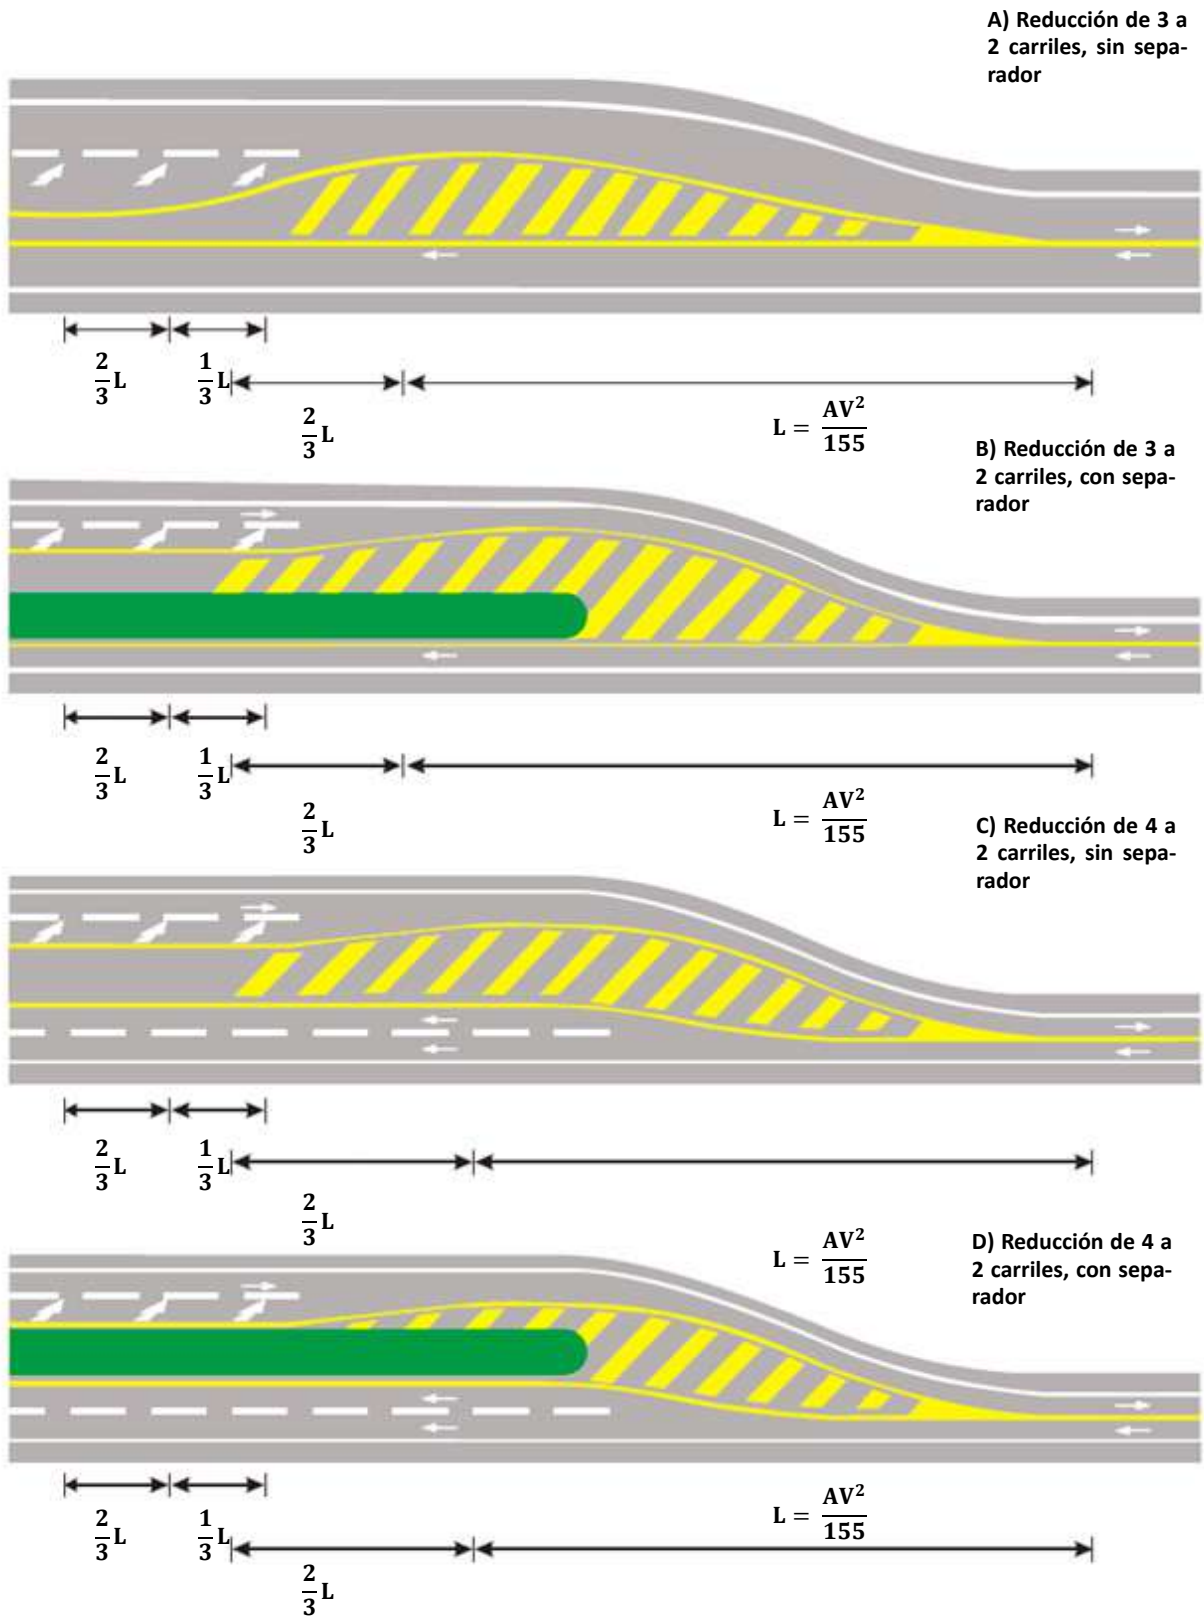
13. DEMARCACIÓN DE TRANSICIÓN EN EL ANCHO DEL PAVIMENTO (DISPOSICIÓN GENERAL)
